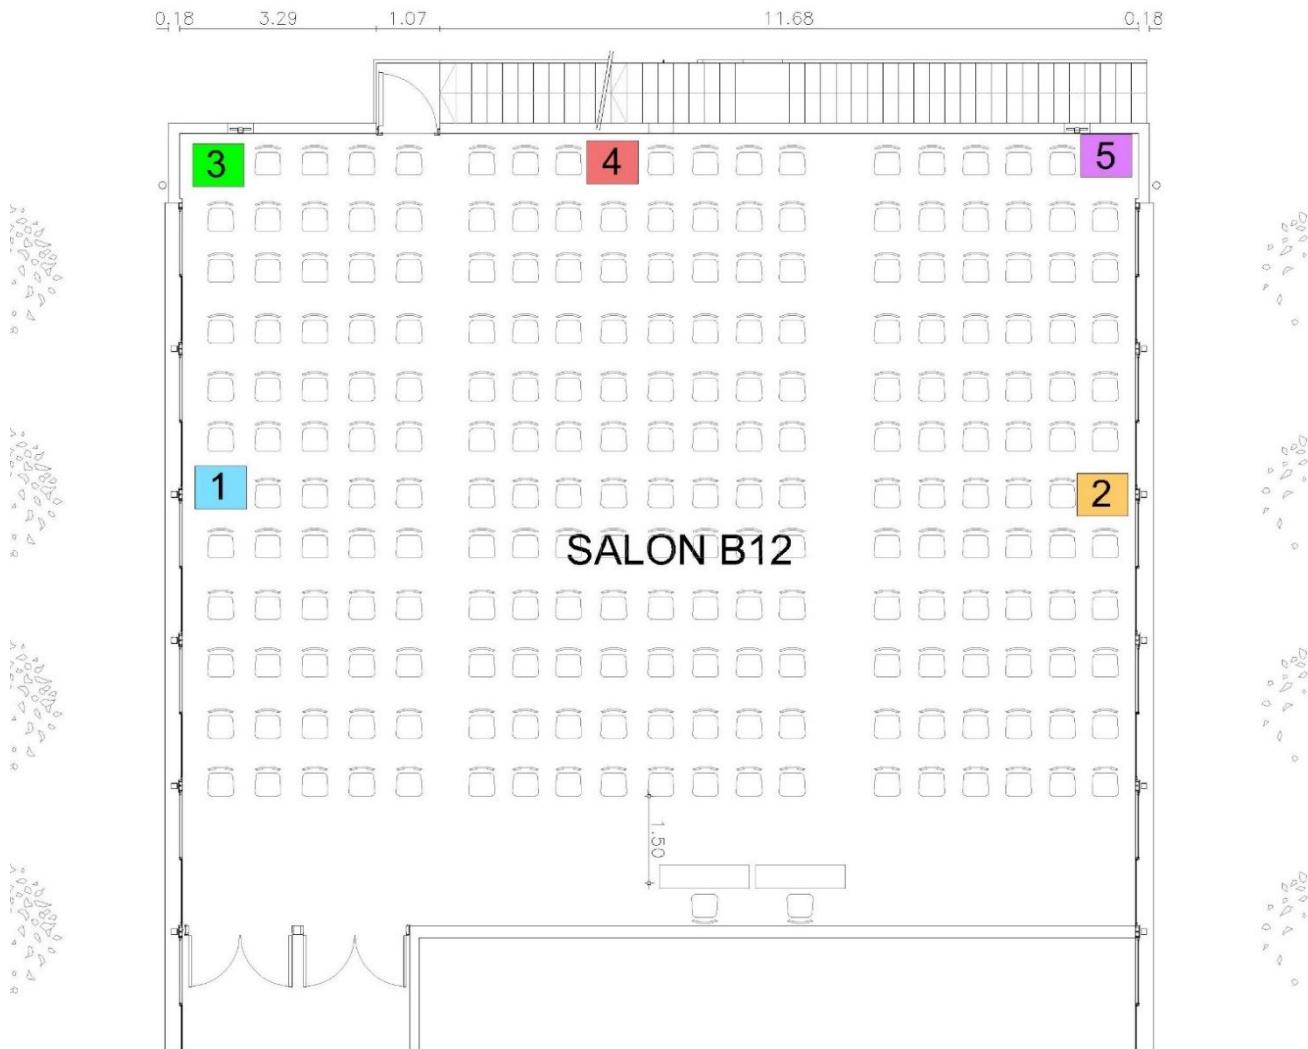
Planta salón B12 con ubicación de lugares para el ensayo
